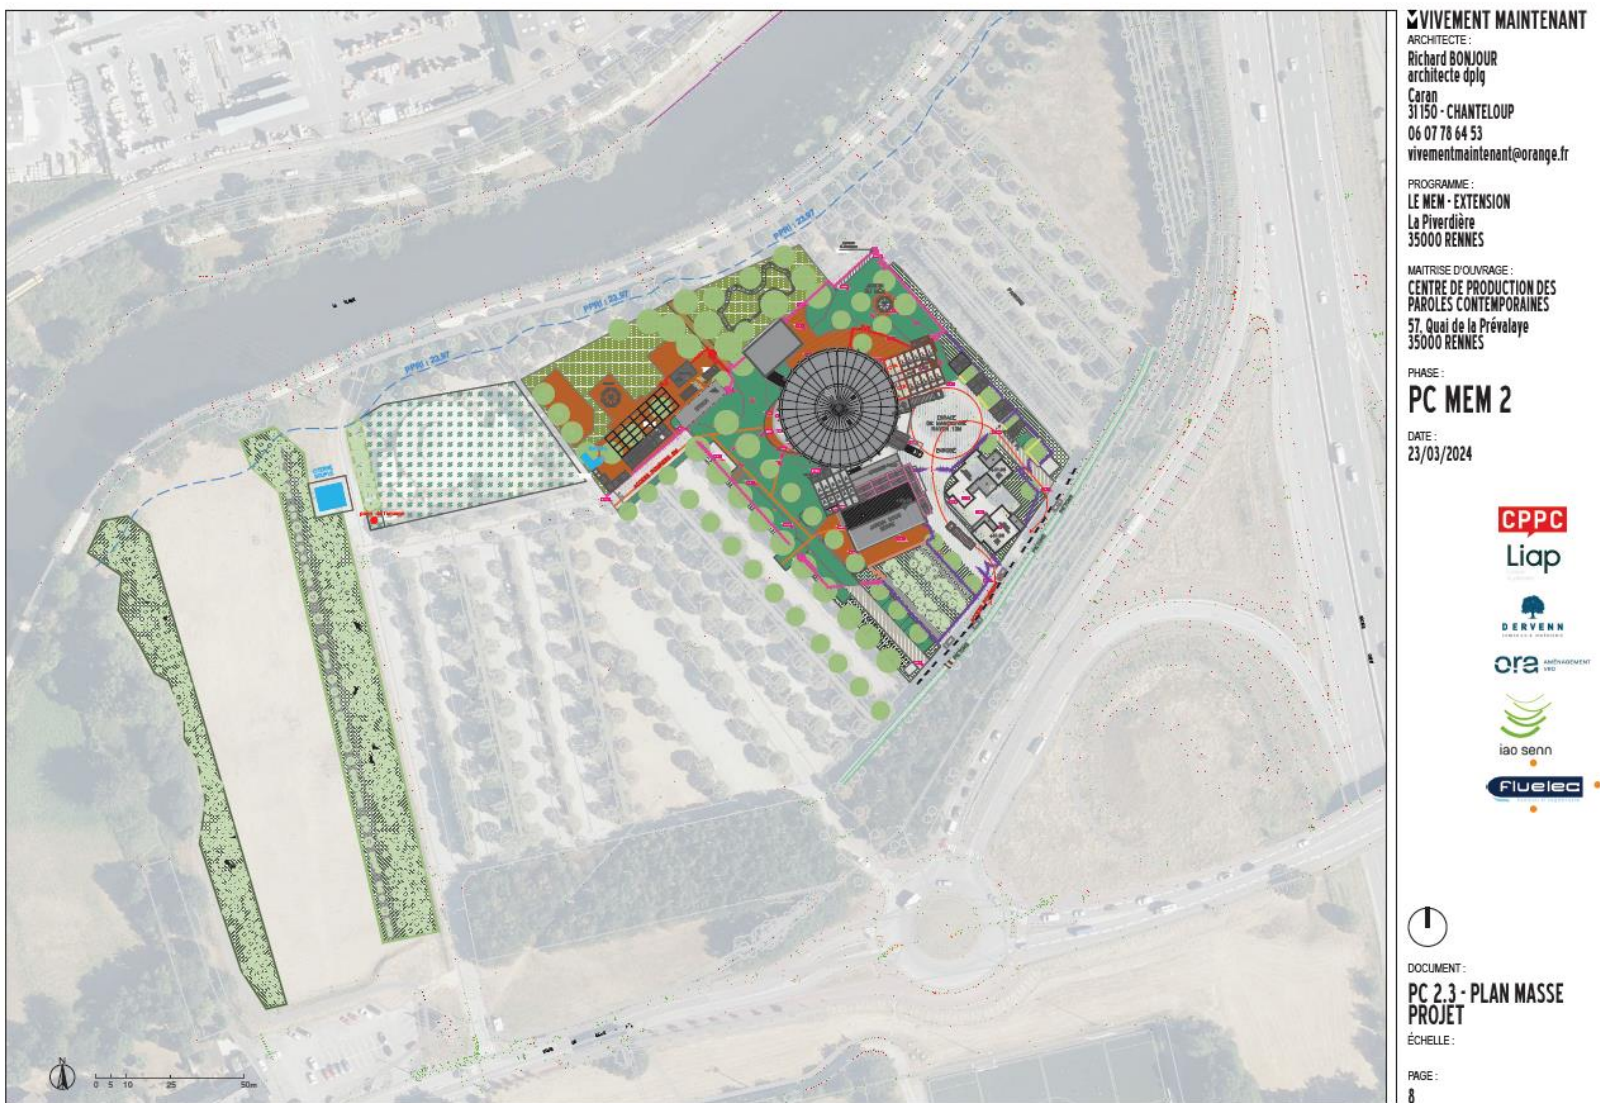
Plan général du projet retenu (Source CPPC/ Vivement Maintenant – mars 2024)
